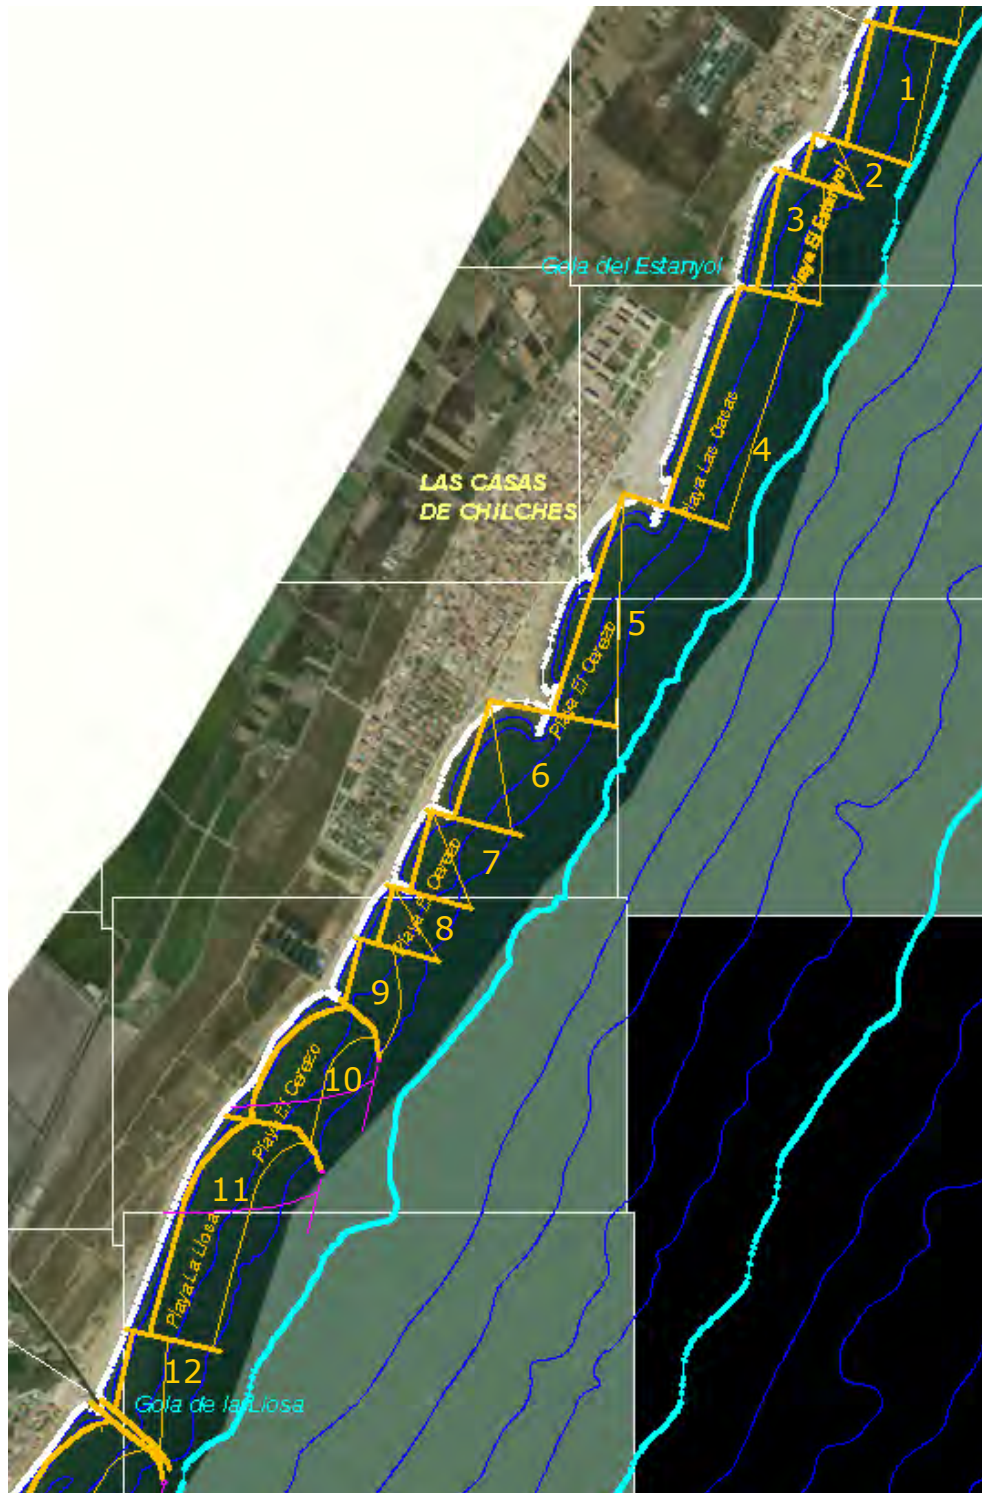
Planta de equilibrio en el tramo 4 de la alternativa 3.2.
